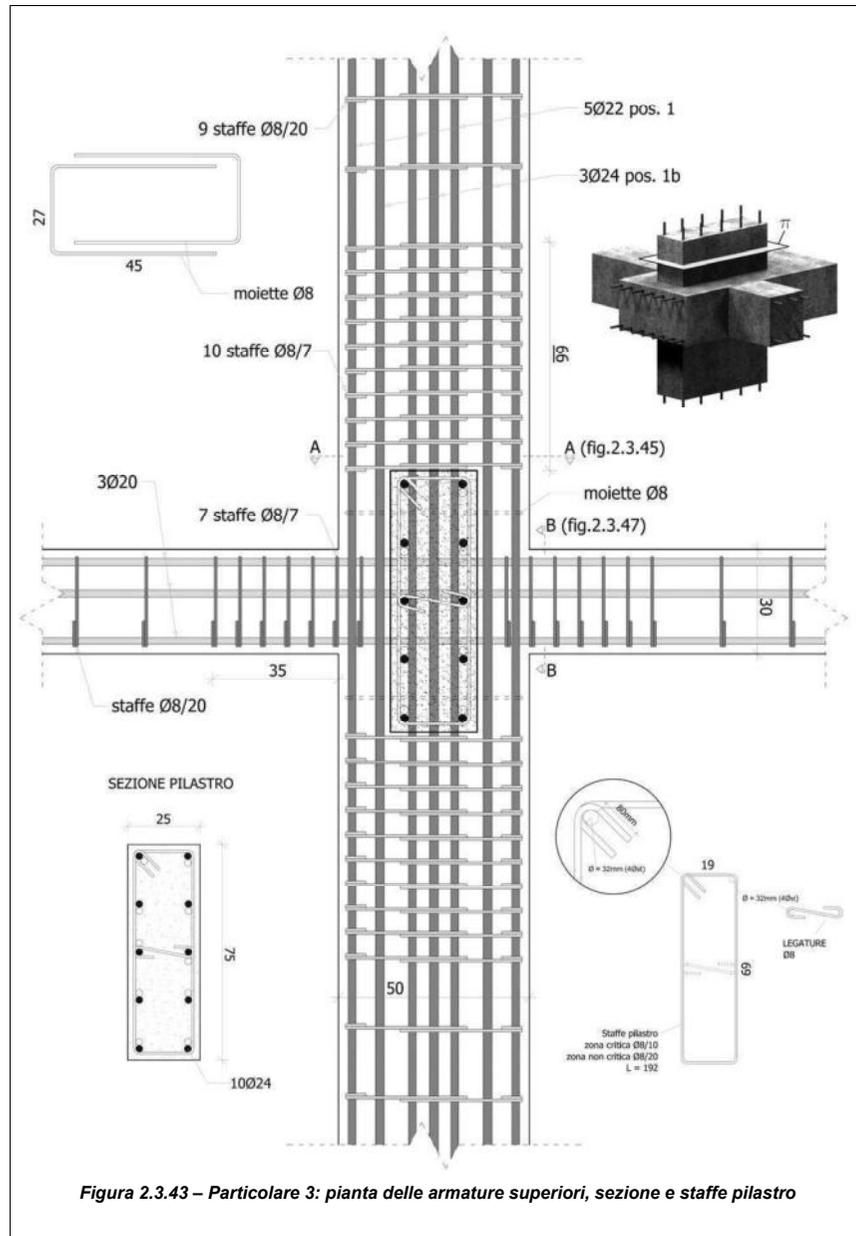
Particolare 3: pianta delle armature superiori, sezione e staffe pilastro
